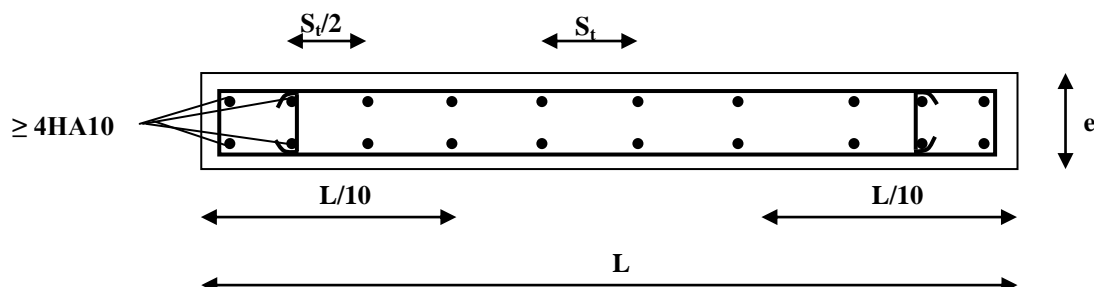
Disposition des armatures verticales dans les voiles.
